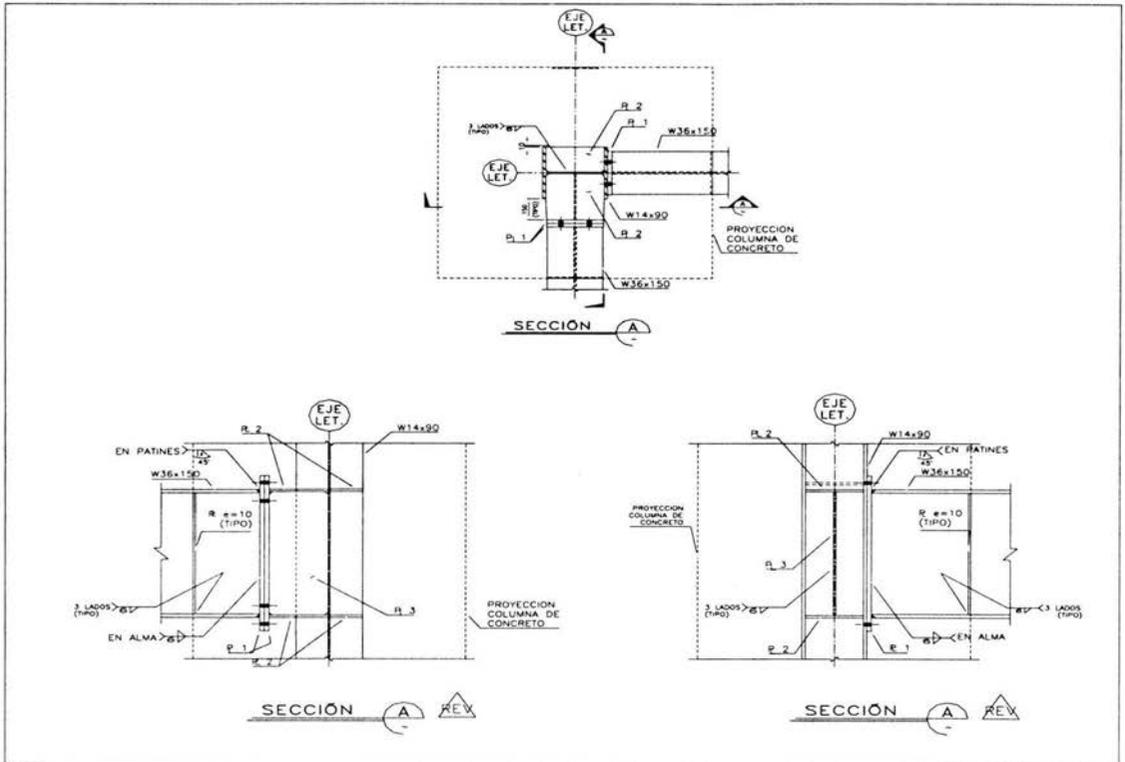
detalles proporcionados por el calculista para el detallado de conexiones.
